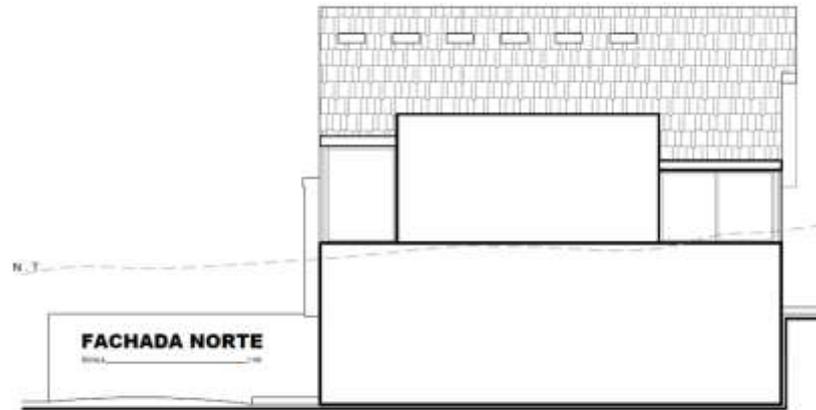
Fachada Norte Casa 14 proyecto "El Peñón del Río"
